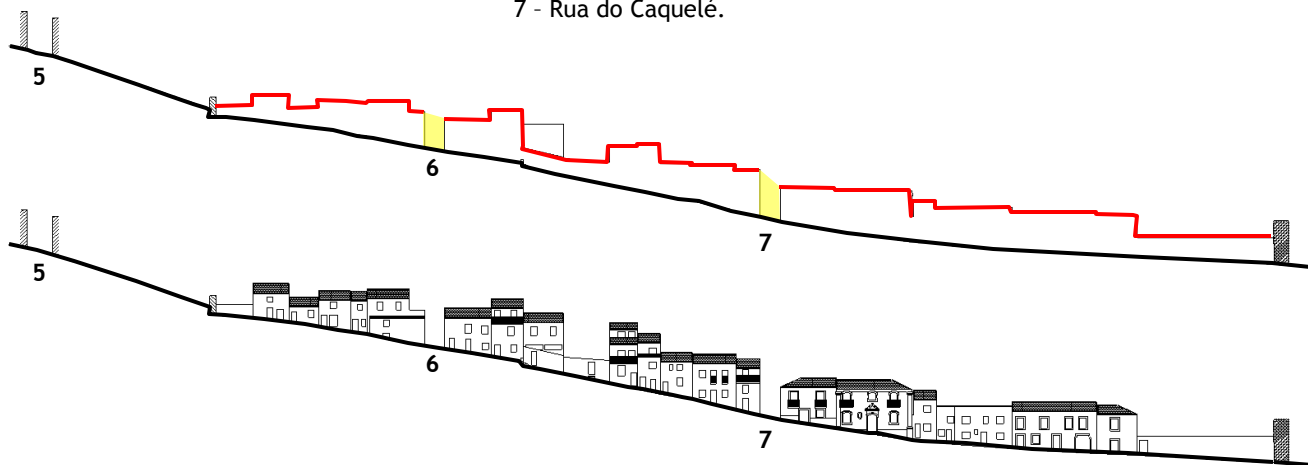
Perfil longitudinal CB_fu2 da Rua do Muro em Castelo Branco - antiga Judiaria.
